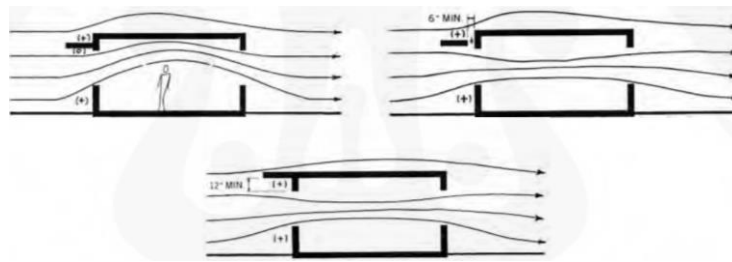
29 Posisi Inlet dan Outlet Berpengaruh di Dalam Ruangan/ Bangunan
